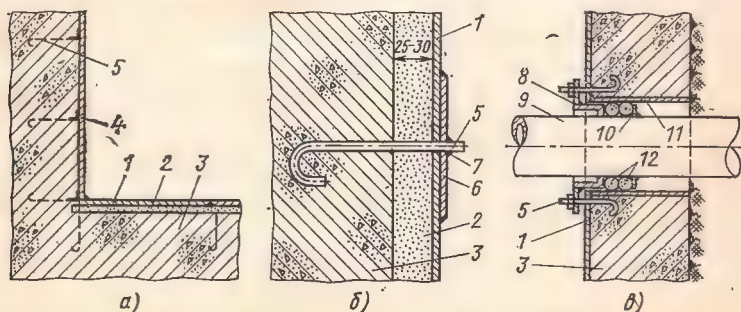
Устройство внутренней металлической гидроизоляции:
